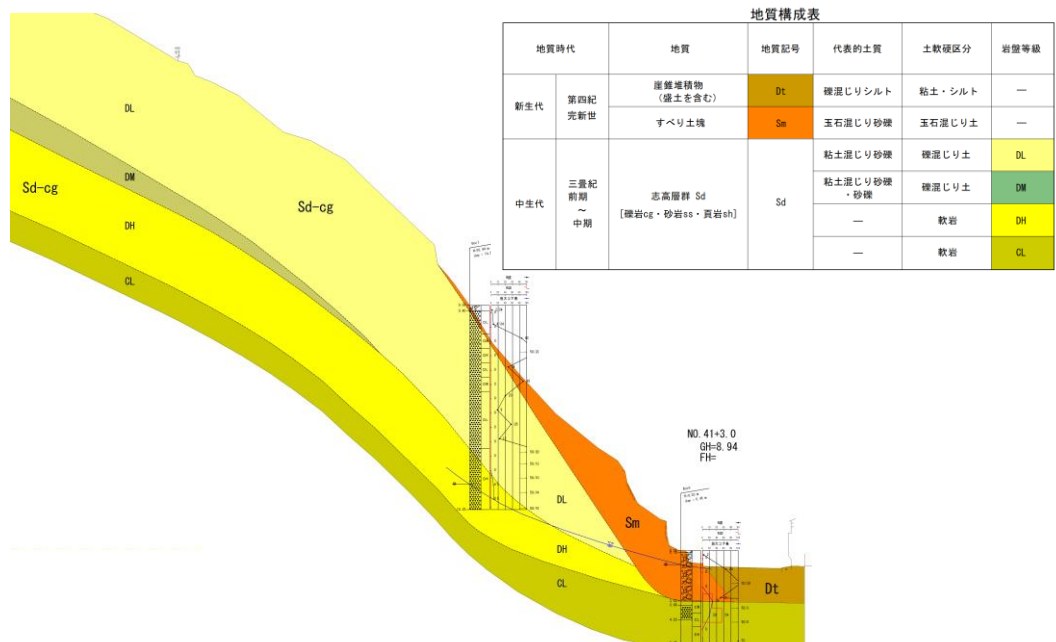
想定地質断面図 (第2工区 NO. 41+3.0)
